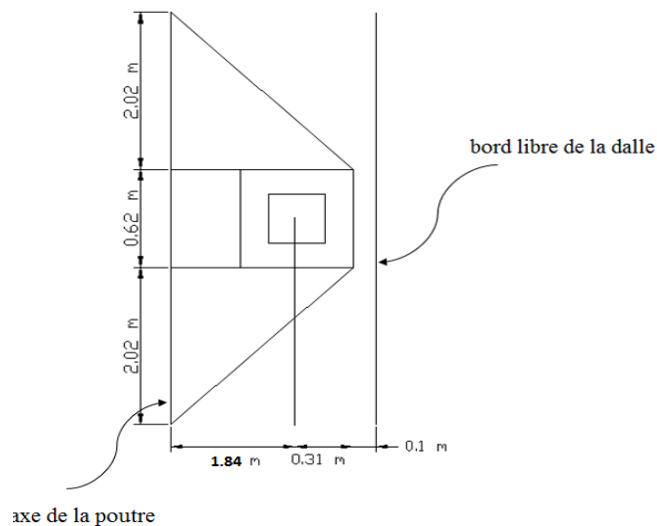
Surcharge de Br sur la dalle d'encorbellement
